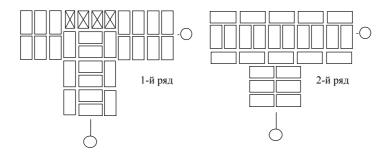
Кладка примыканий стен толщиной в 2 кирпича
